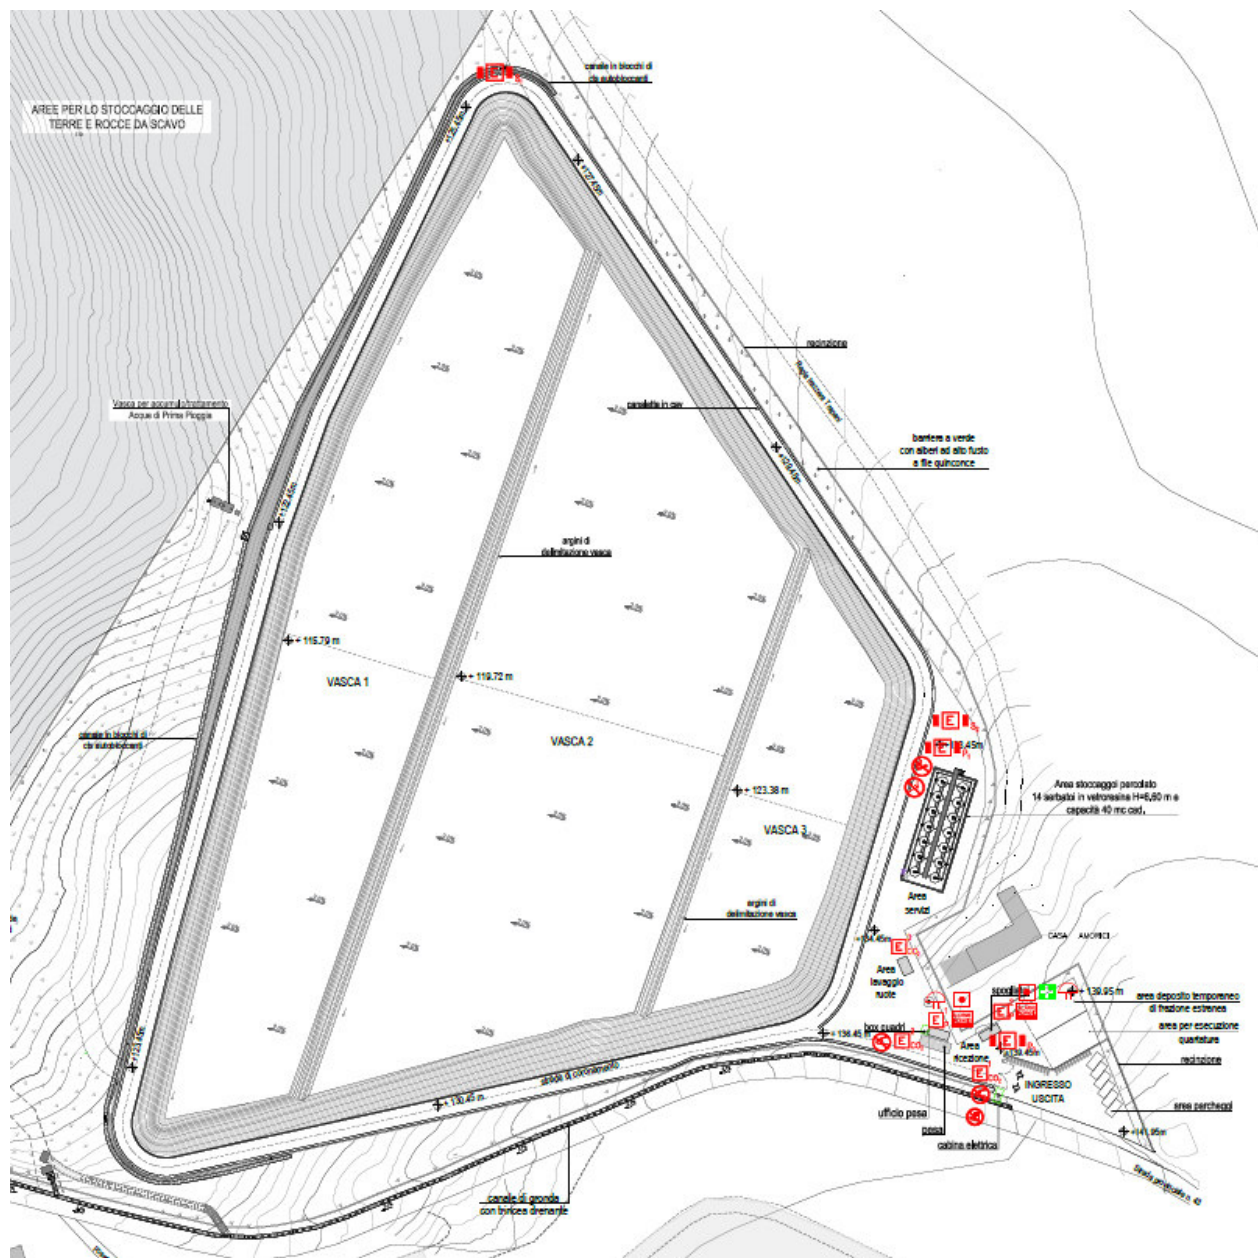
PLANIMETRIA PRESIDI ANTINCENDIO
